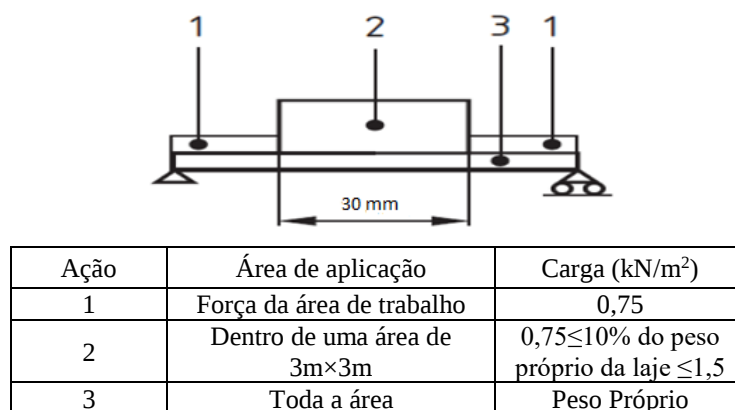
Sobrecargas de construção para a chapa perfiladas utilizadas como cofragem (Gonçalves, 2016)
